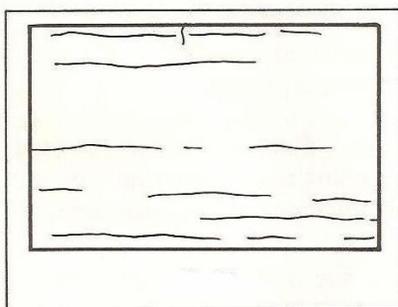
fissura horizontal (VERÇOZA, 1991, p. 56)
